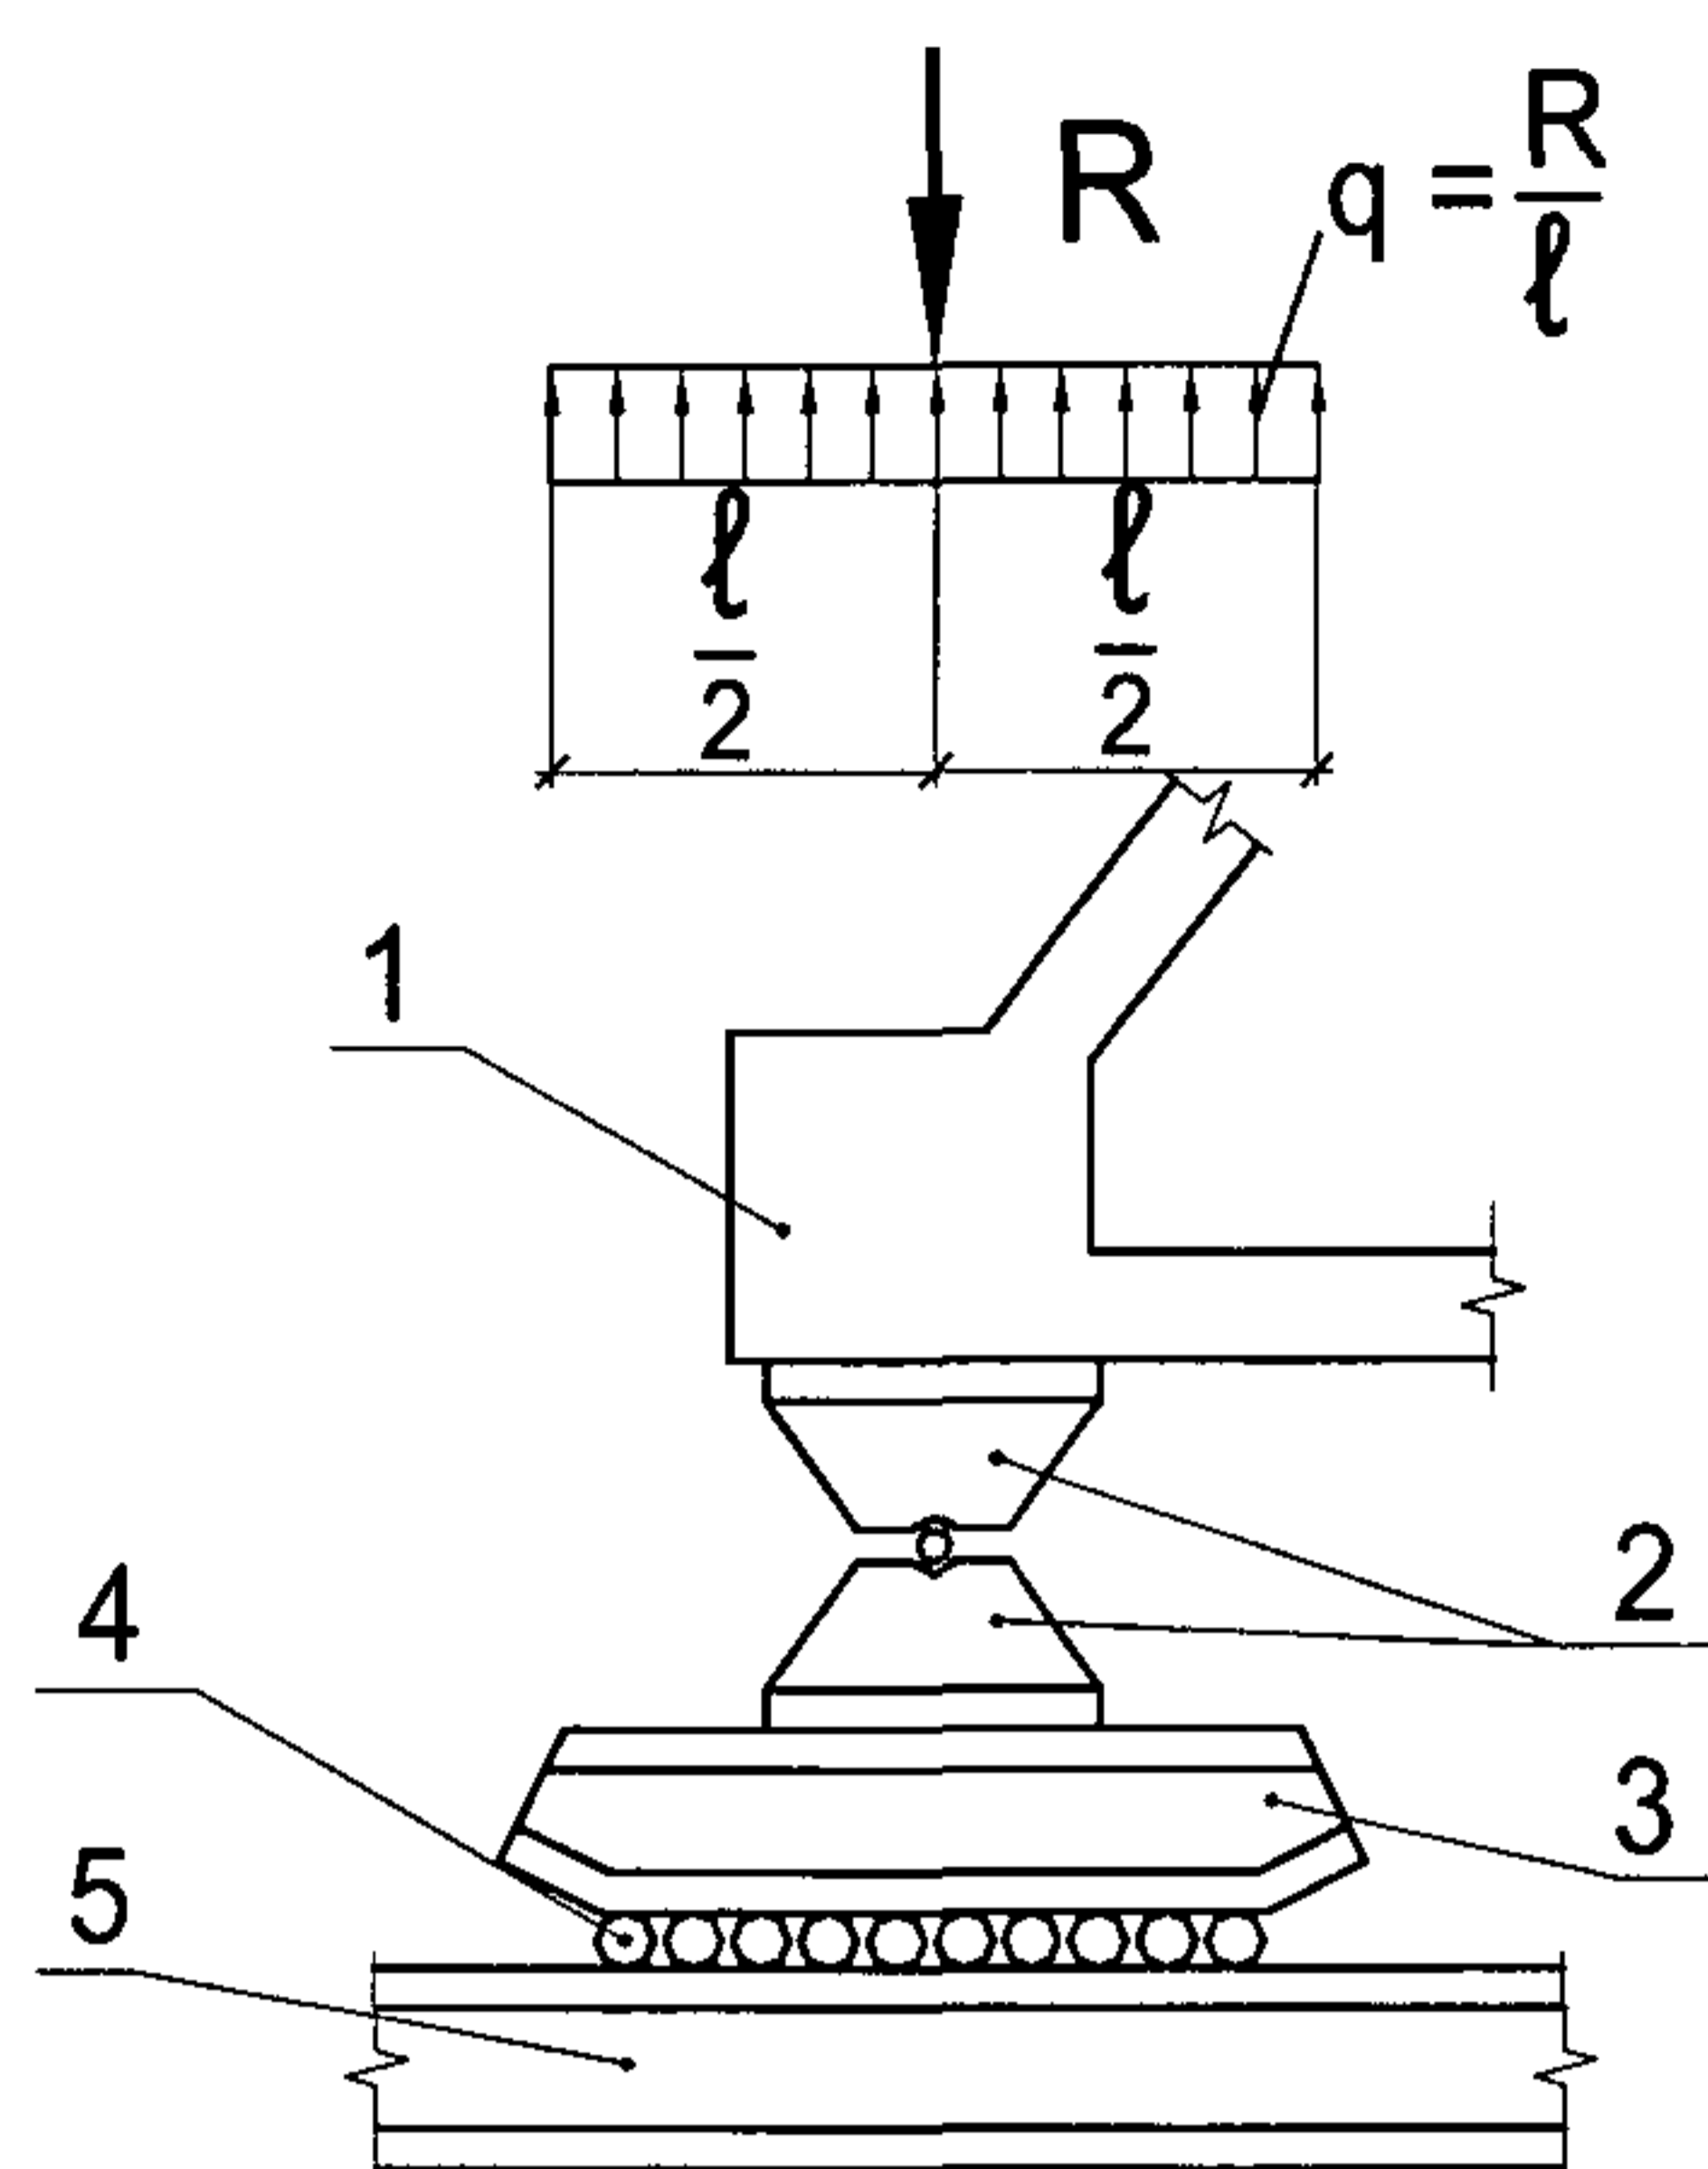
Балансирное опирание узла пролетного строения на накаточные пути при продольной надвижке на плаву
